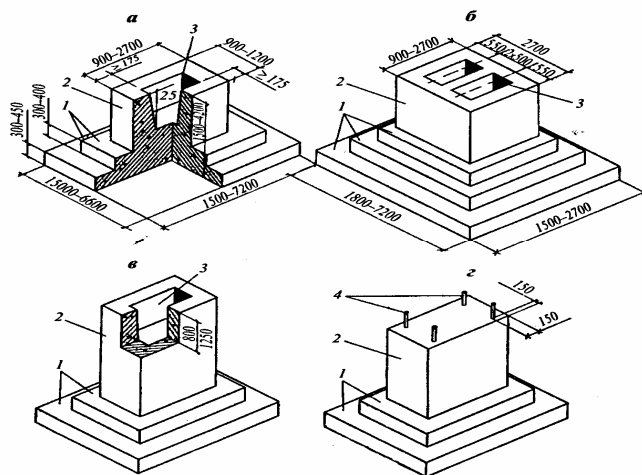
Монолитные железобетонные фундаменты стаканного типа:
